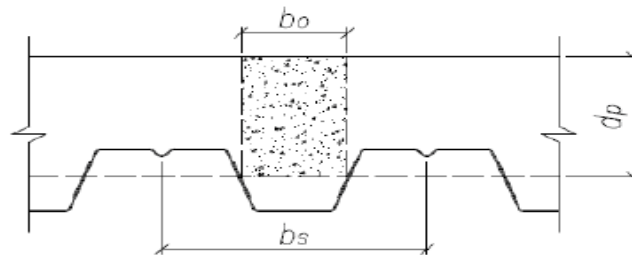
Dimensões genéricas da laje mista com chapa perfilada (Gonçalves, 2016)
